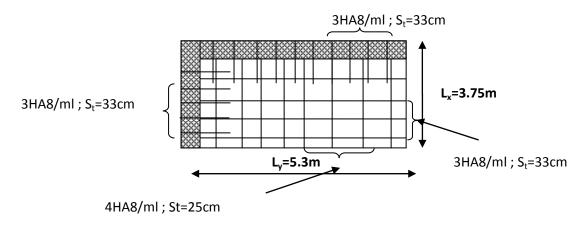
schéma de ferraillage de la dalle sur deux appuis
